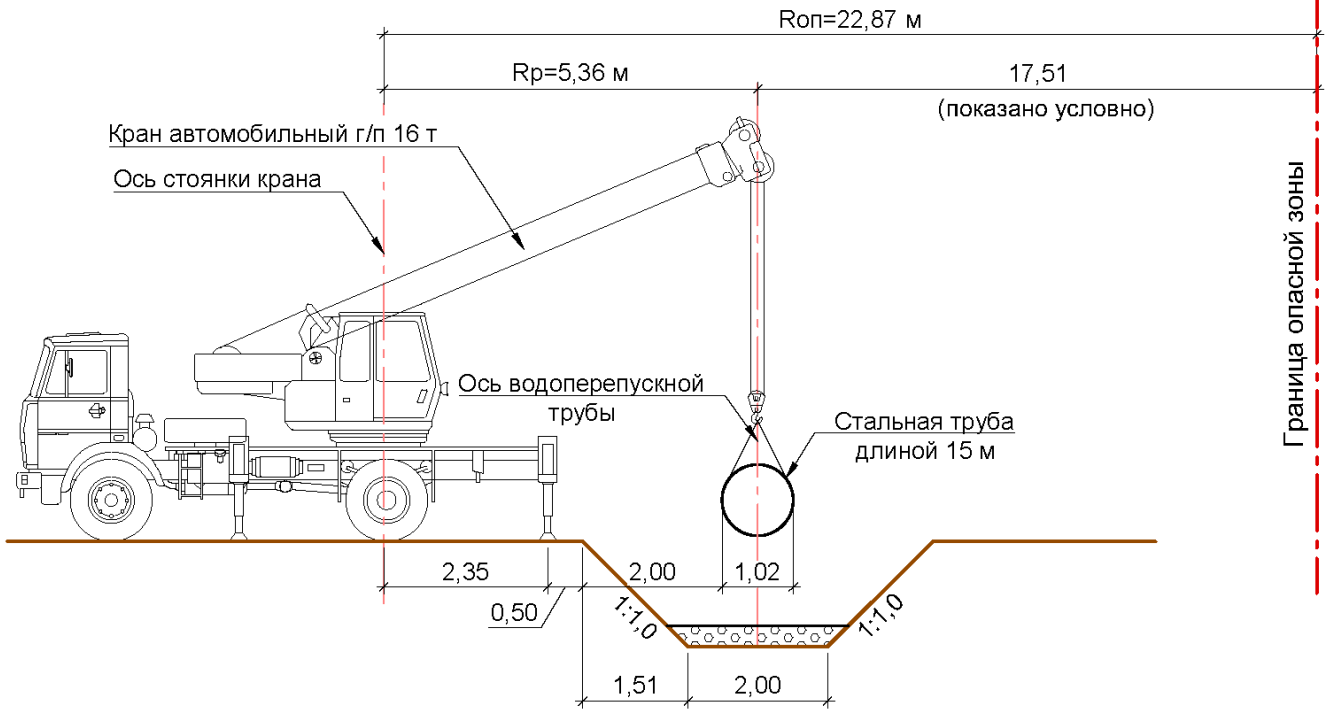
Граница опасной зоны работы крана при монтаже стальной водоперепускной трубы
